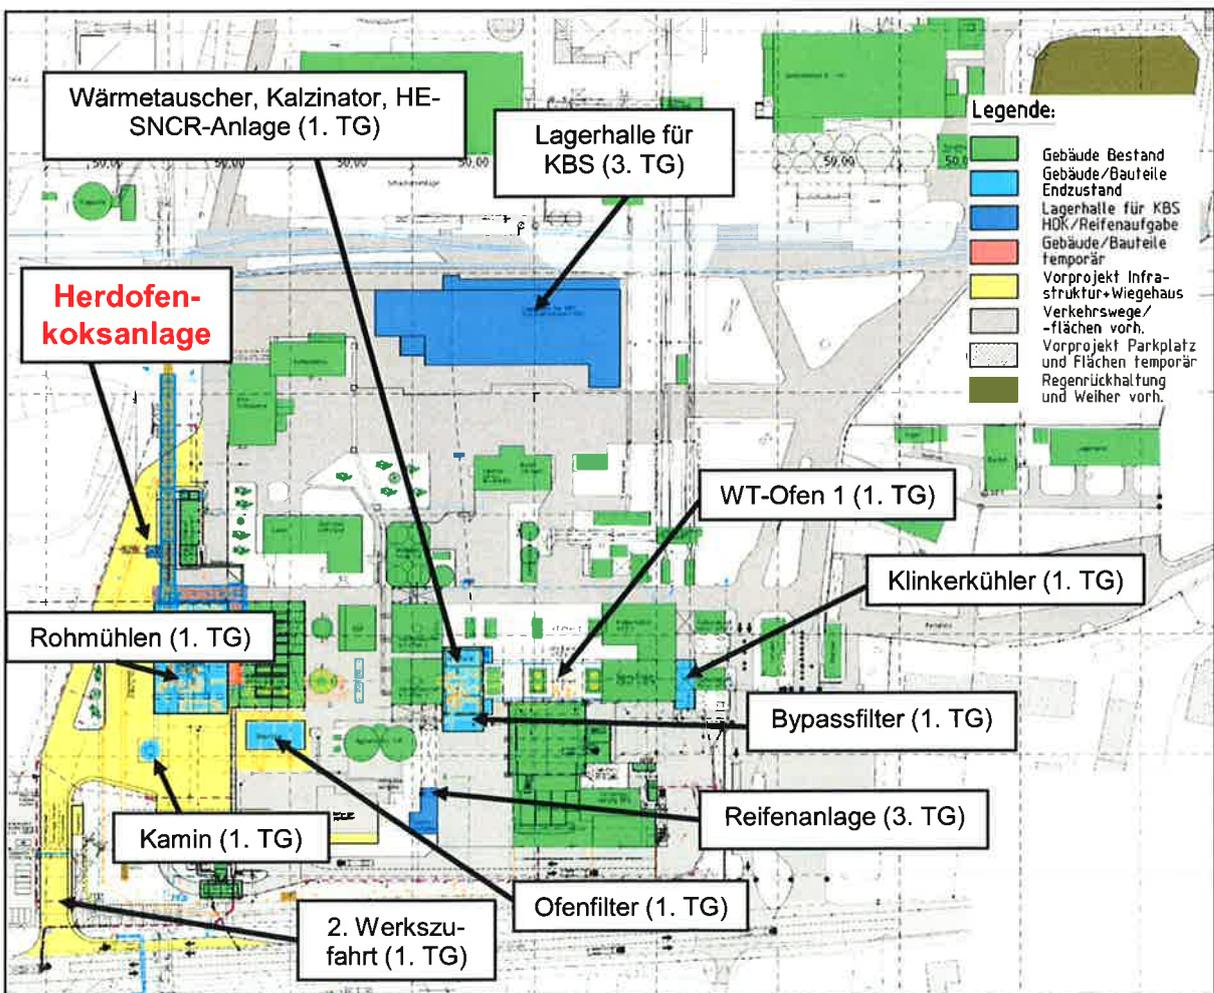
Übersichtslageplan modernisiertes Zementwerk Burglengenfeld mit geplanter Herdofenkoksanlage
